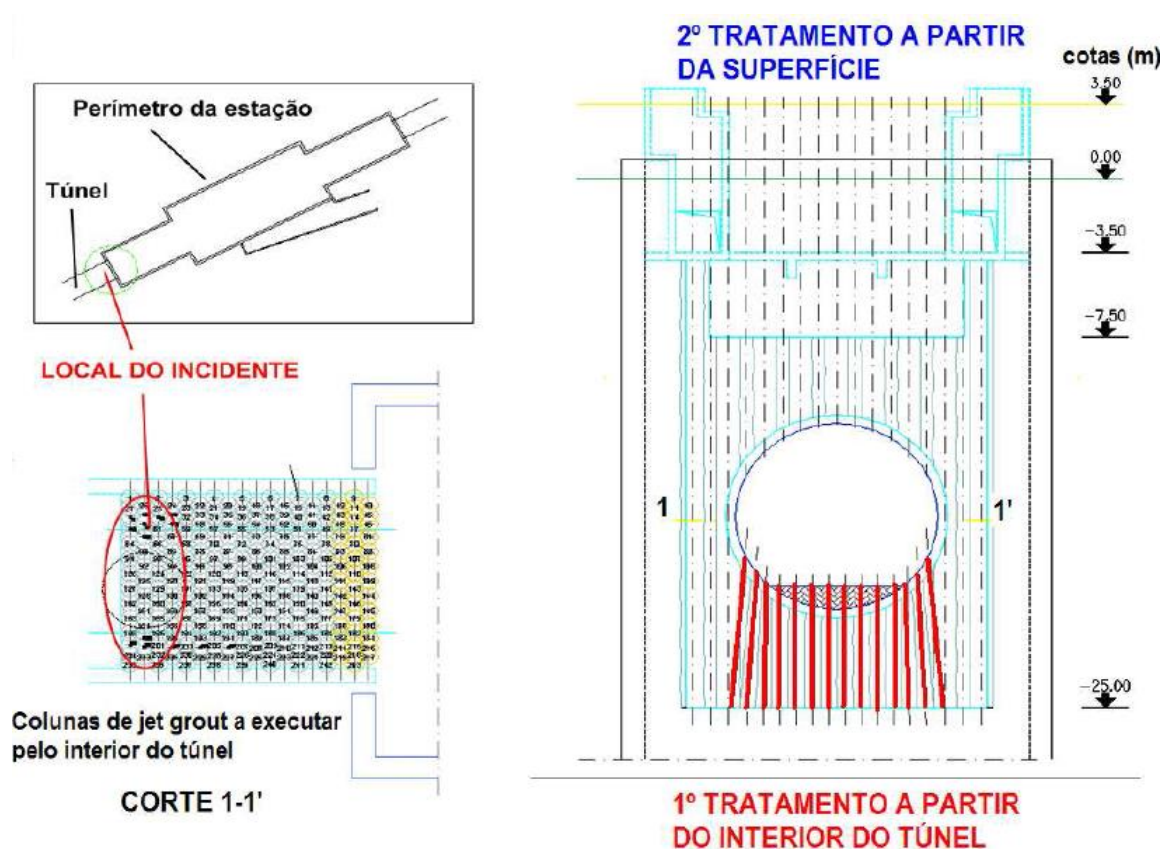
Esquema da execução do jet-grouting em torno do túnel pré-existente, para impermeabilização dos emboquilhamentos (Salgado, 2014)
